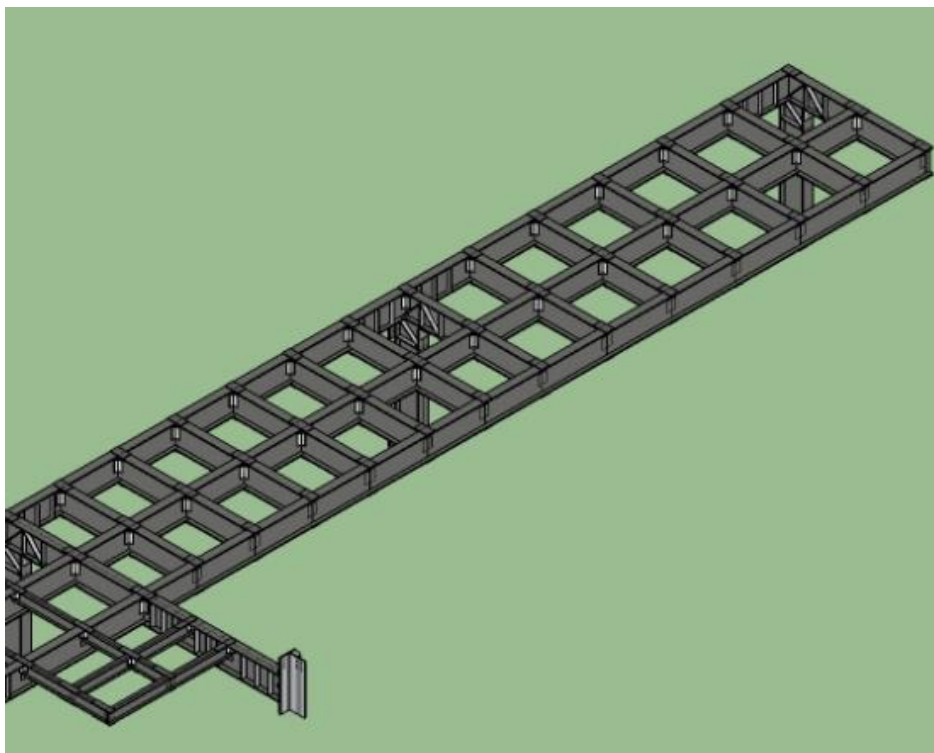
Distribuição das vigas metálicas do mezanino 2.
